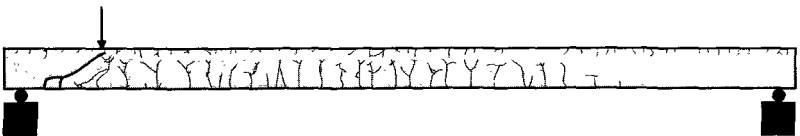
Rissbild Balken G04 nach dem anschließenden Schubversuch
